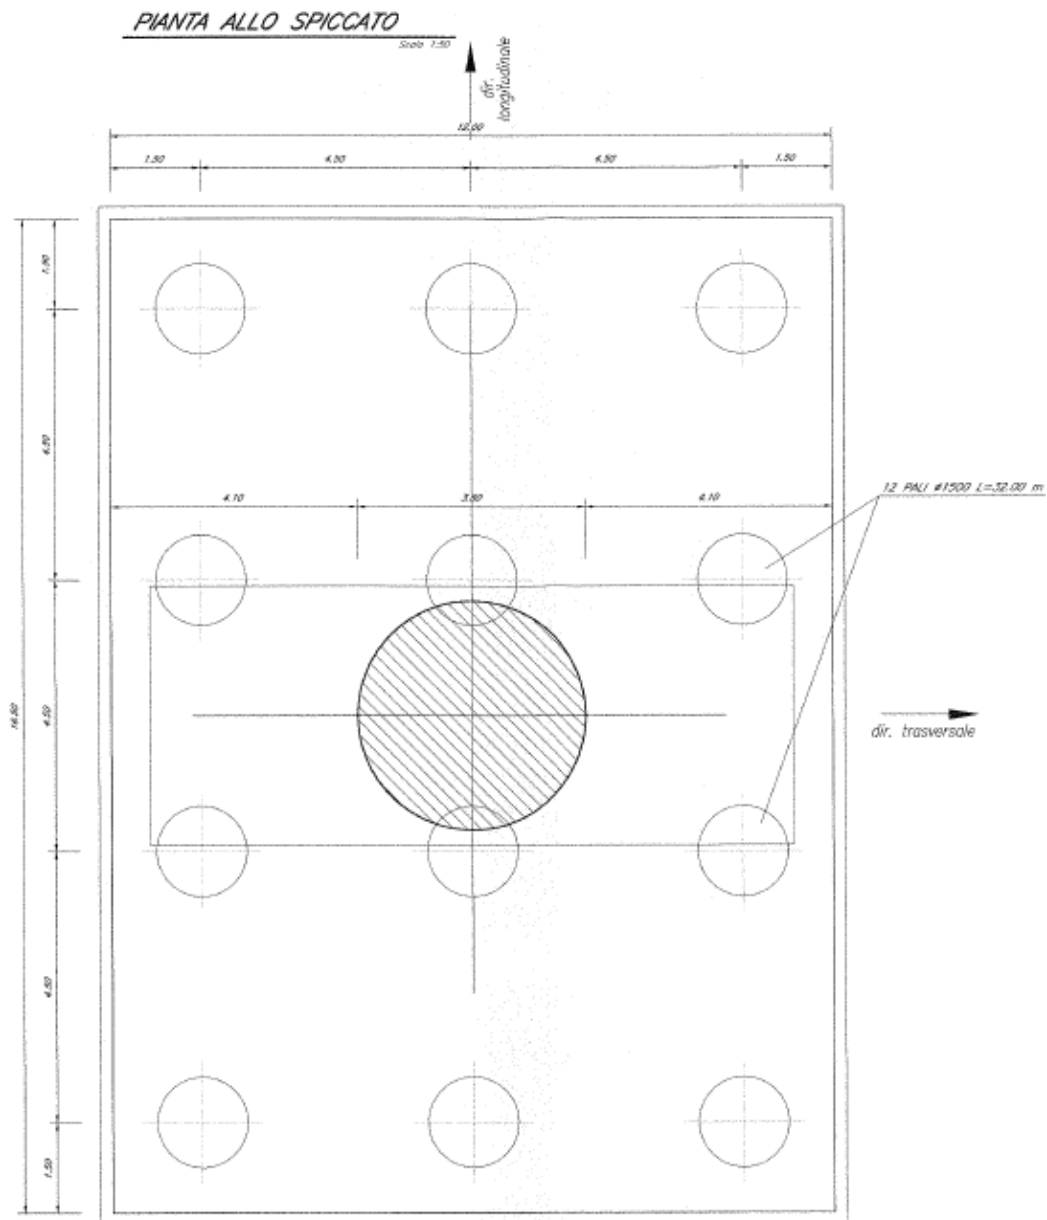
Plinto di fondazione e pali, vista in pianta - Sezione del fusto pila [m]
